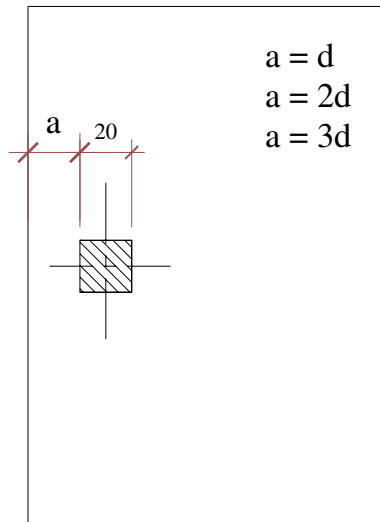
Ligações laje-pilar de borda com *overhang
